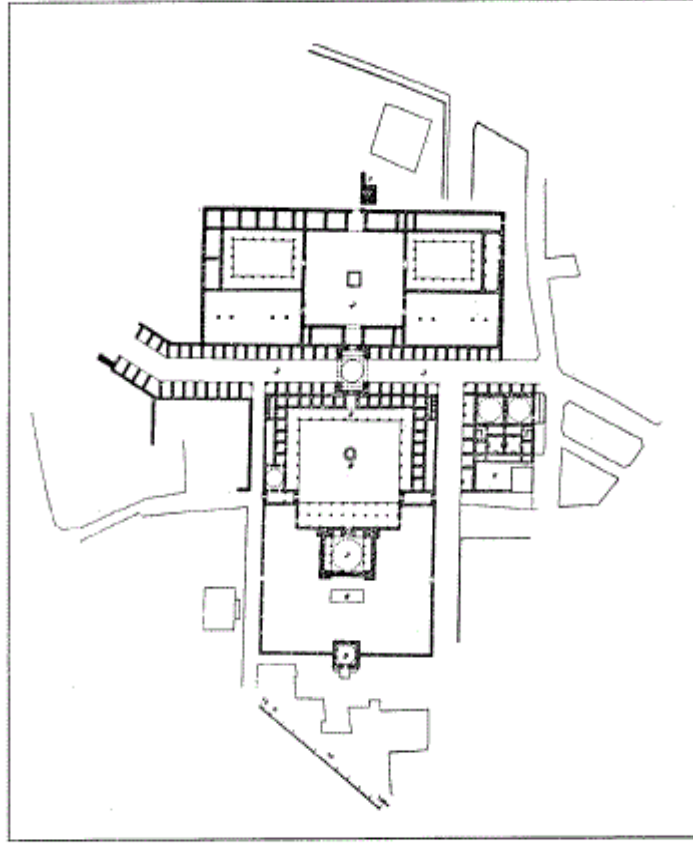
مسقط أفقي لمدرسة محمد باشا في فونچا (عن: Pašić).
